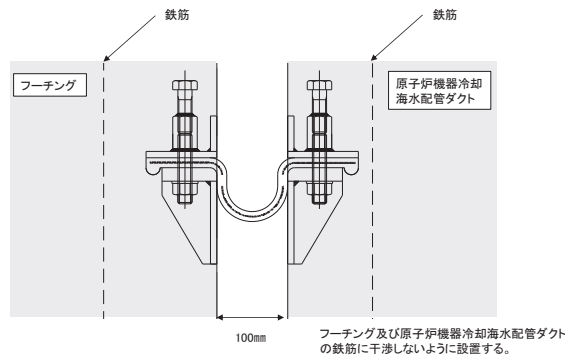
(3) 止水パターン③の止水ジョイント構造概要(Q型ジョイント施工イメージ)
